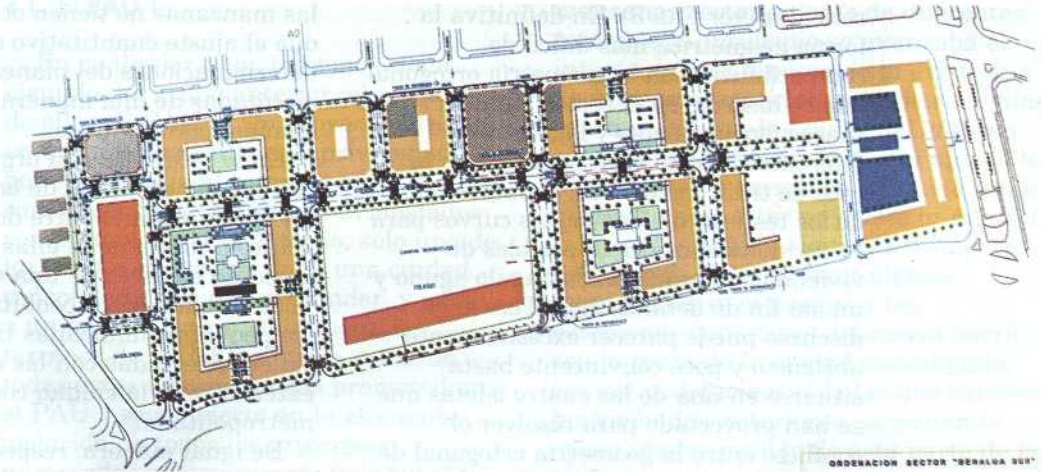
Planta del PP.1-2 Benalúa Sur.
